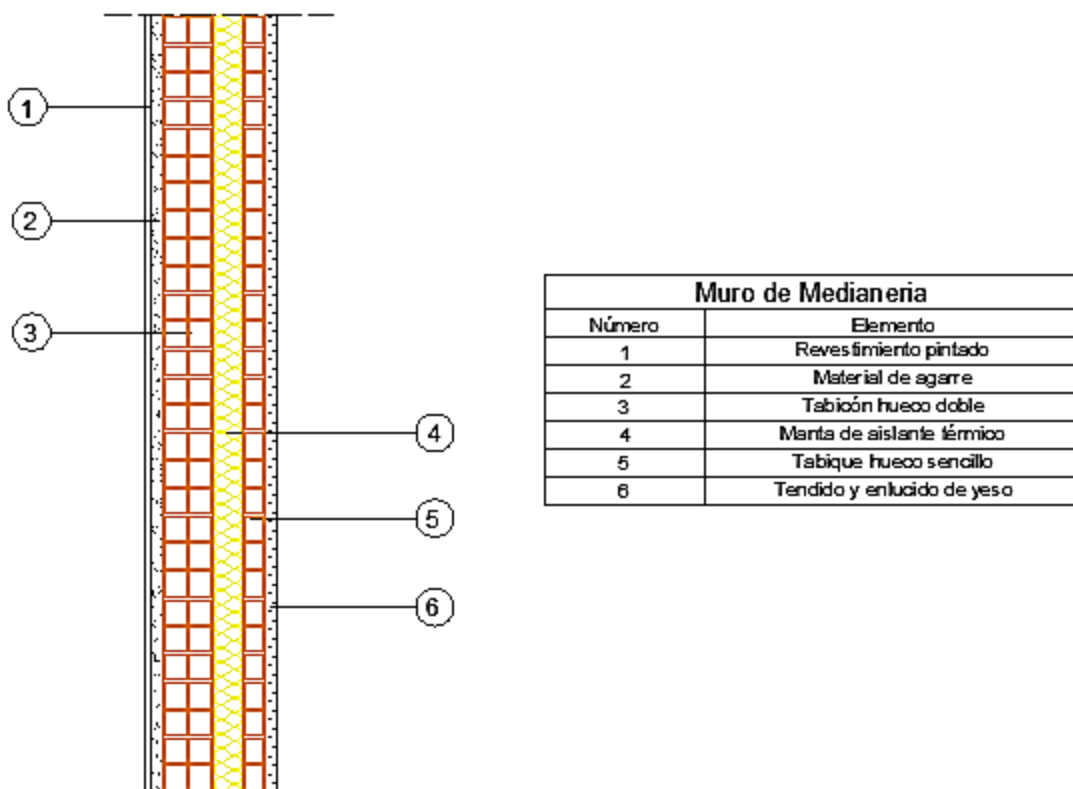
Detalle muro de medianera [Anexo II. Planos]
